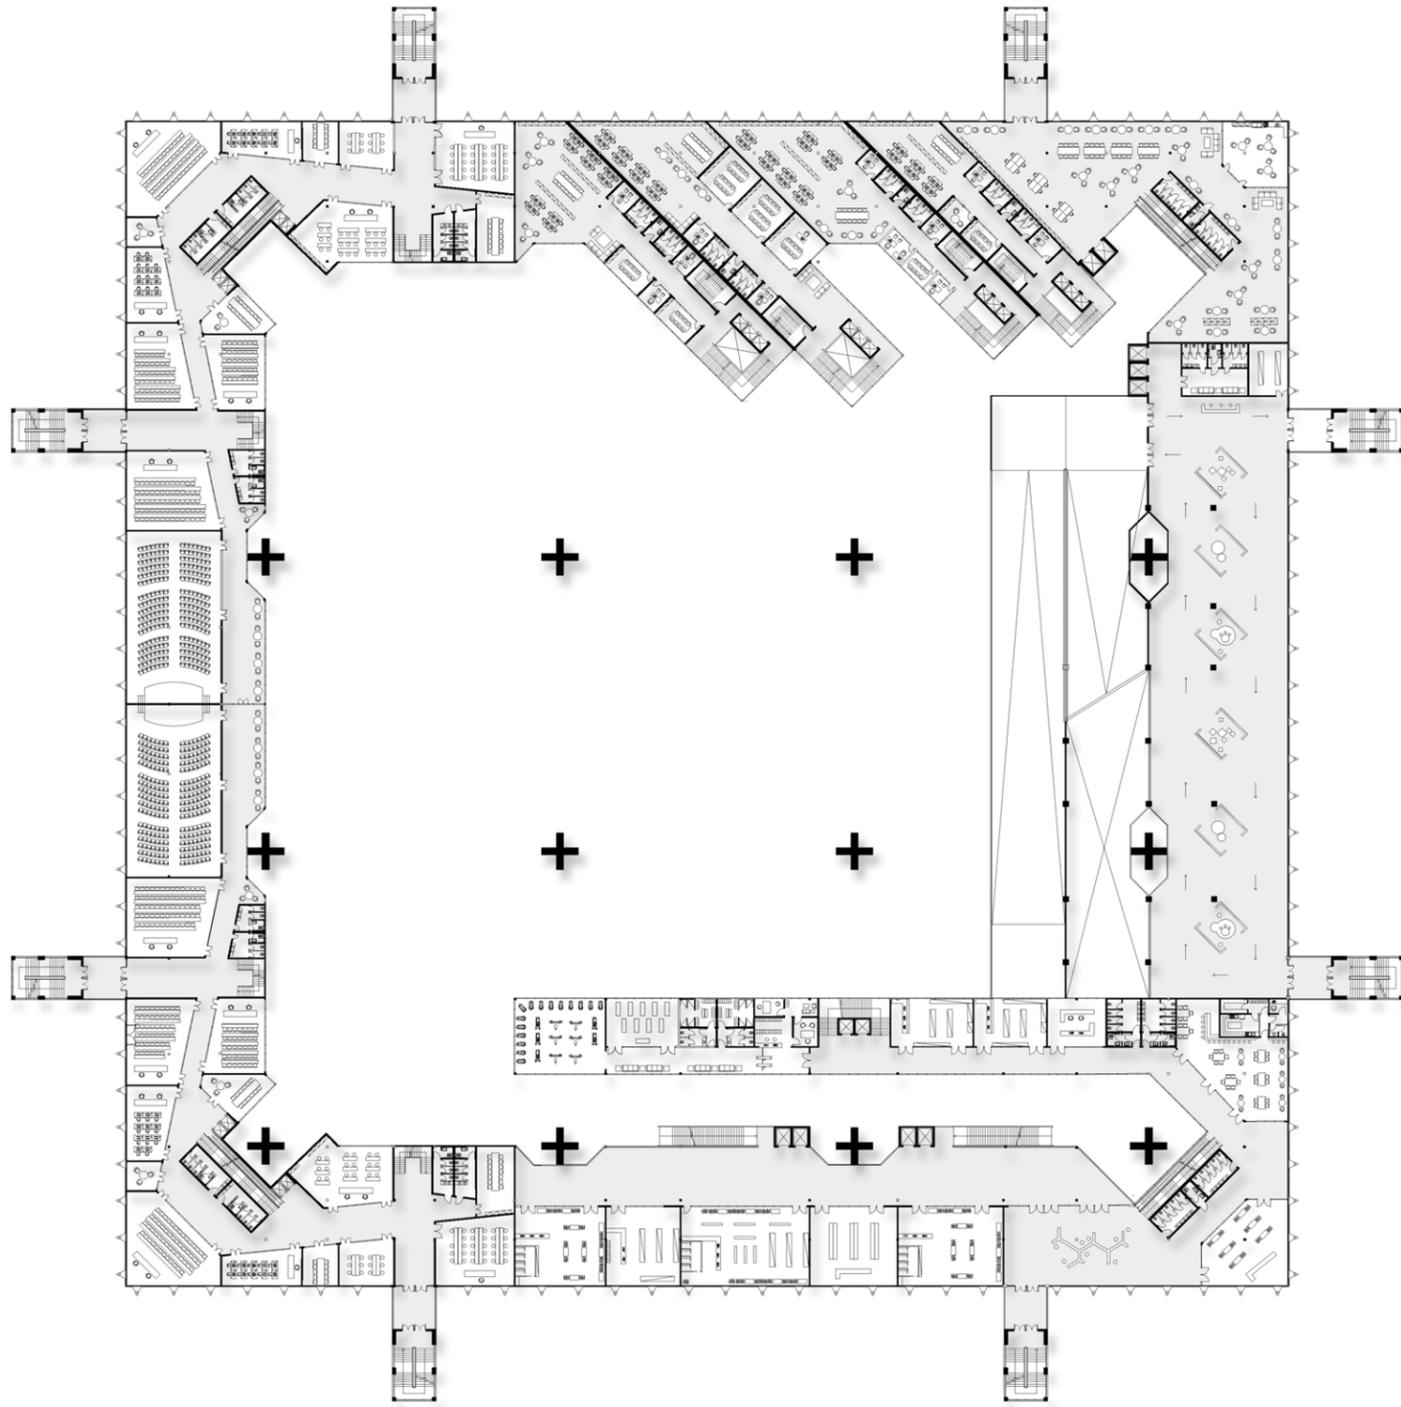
Pianta piano primo dell'intervento Disomogeneità Omogenea, elaborato degli autori.
